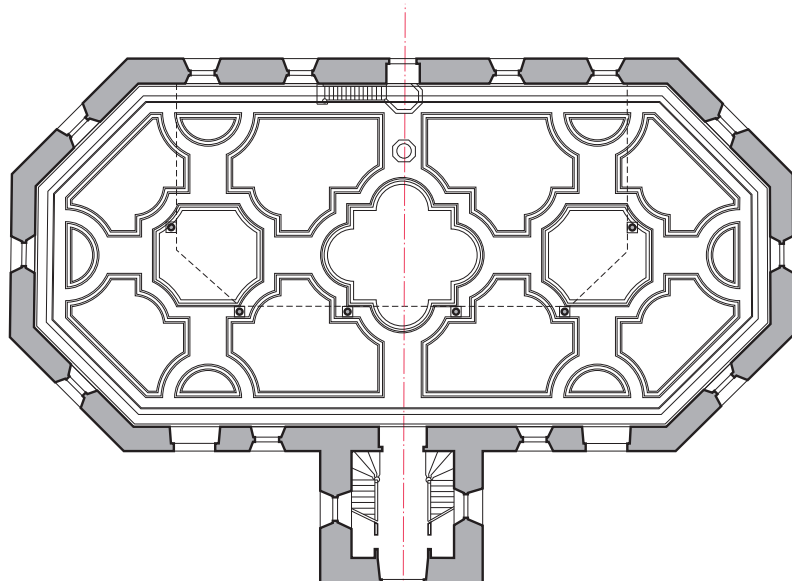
Grundriss der reformierten Kirche Zurzach.
